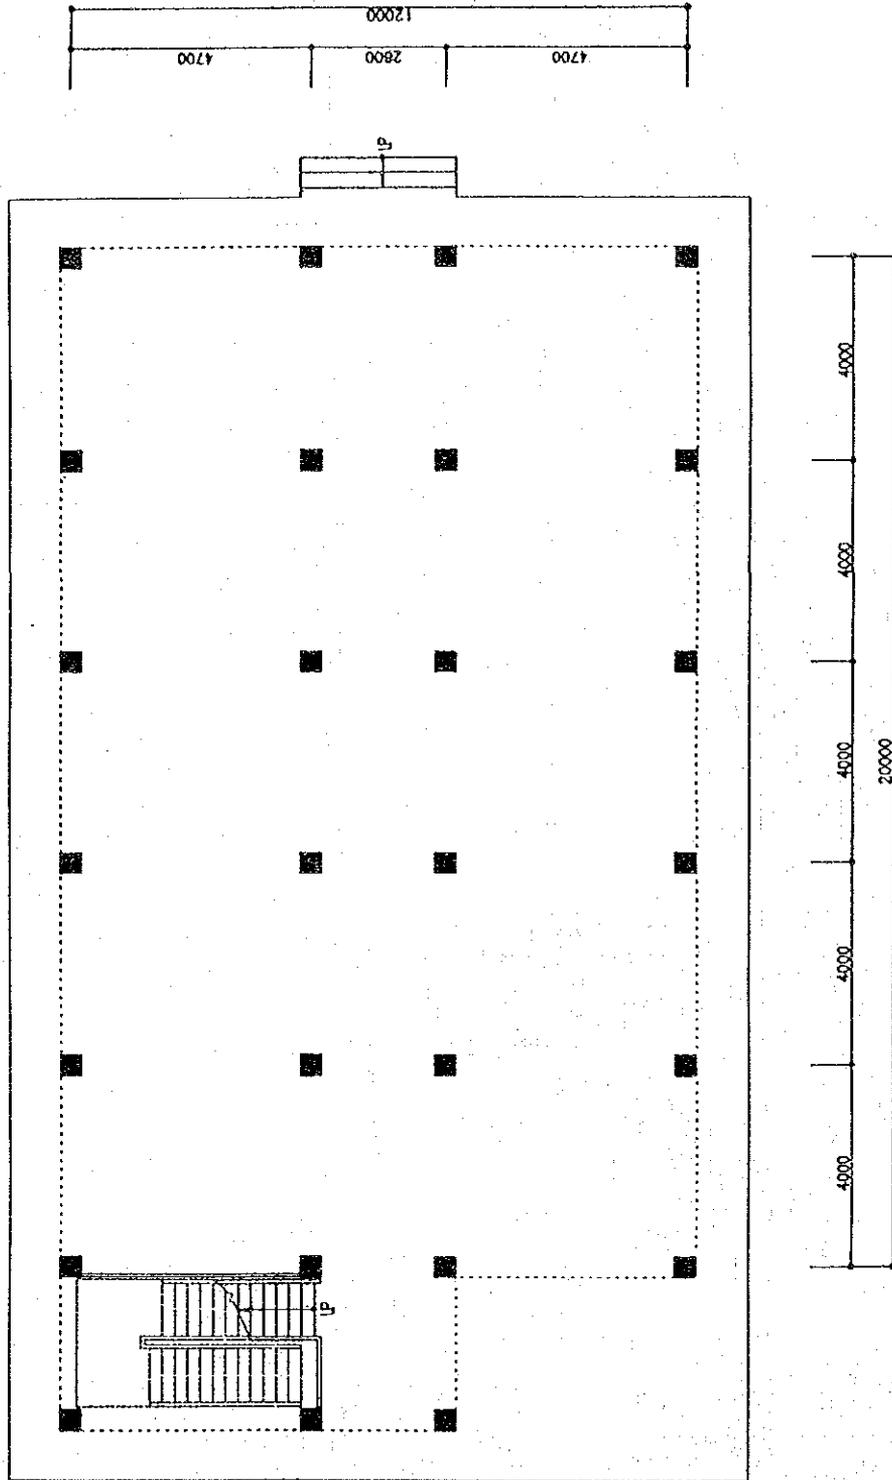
(1) 1 階平面図 (3 教室タイプ)
